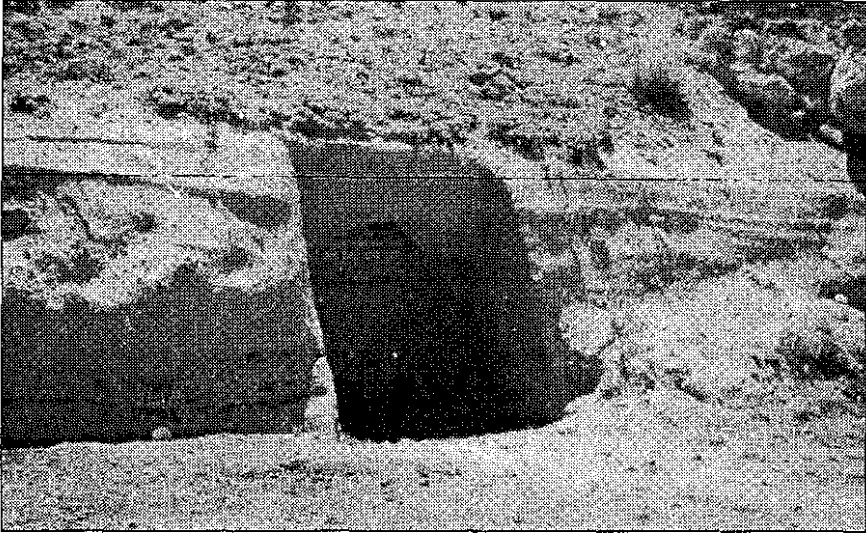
Ambar girişinde kapı üzerleri beton kirişle kaplanarak, beton sütunlarla desteklenmektedir.
